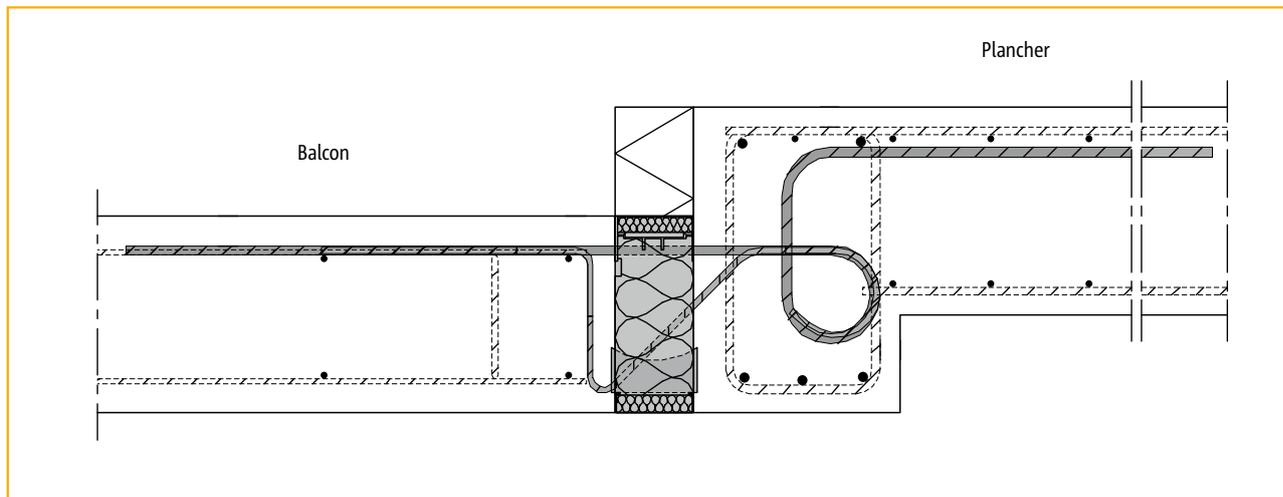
Encastrement du Schöck Isokorb® modèle K.. sk (sk = flexion dans la poutre de rive/décrochement vers le haut)
